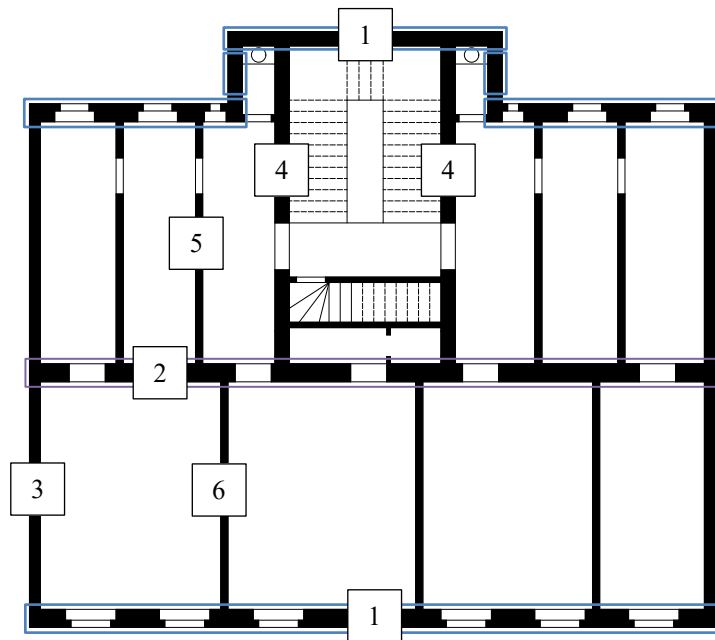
Gründerzeitgebäude im Grundriss
